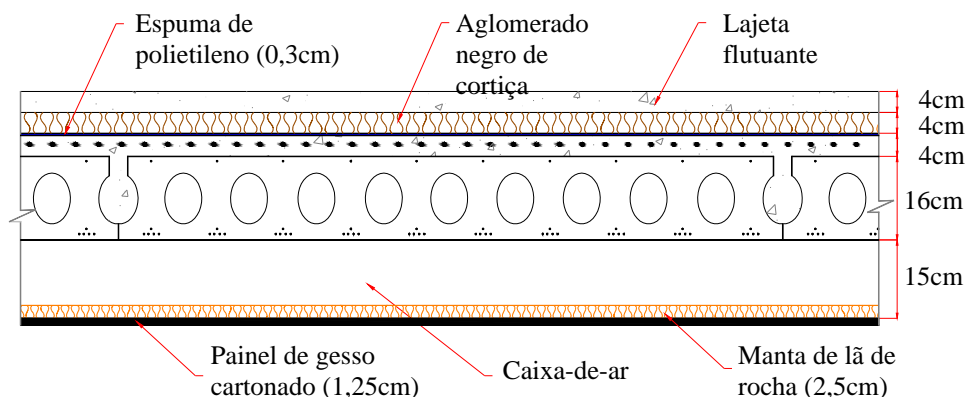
Pavimento em painéis alveolares com tecto falso, isolante térmico e lajeta flutuante (Pav9)
